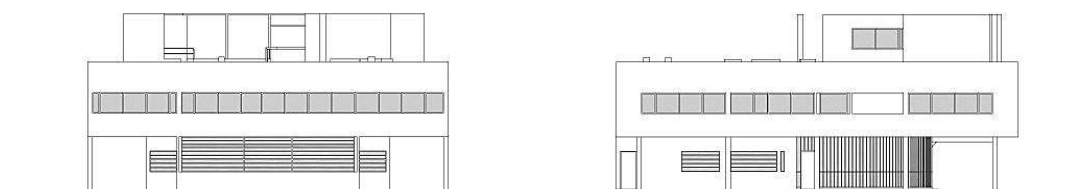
Villa Savoy. Façades avec des fenêtres en bandeau
